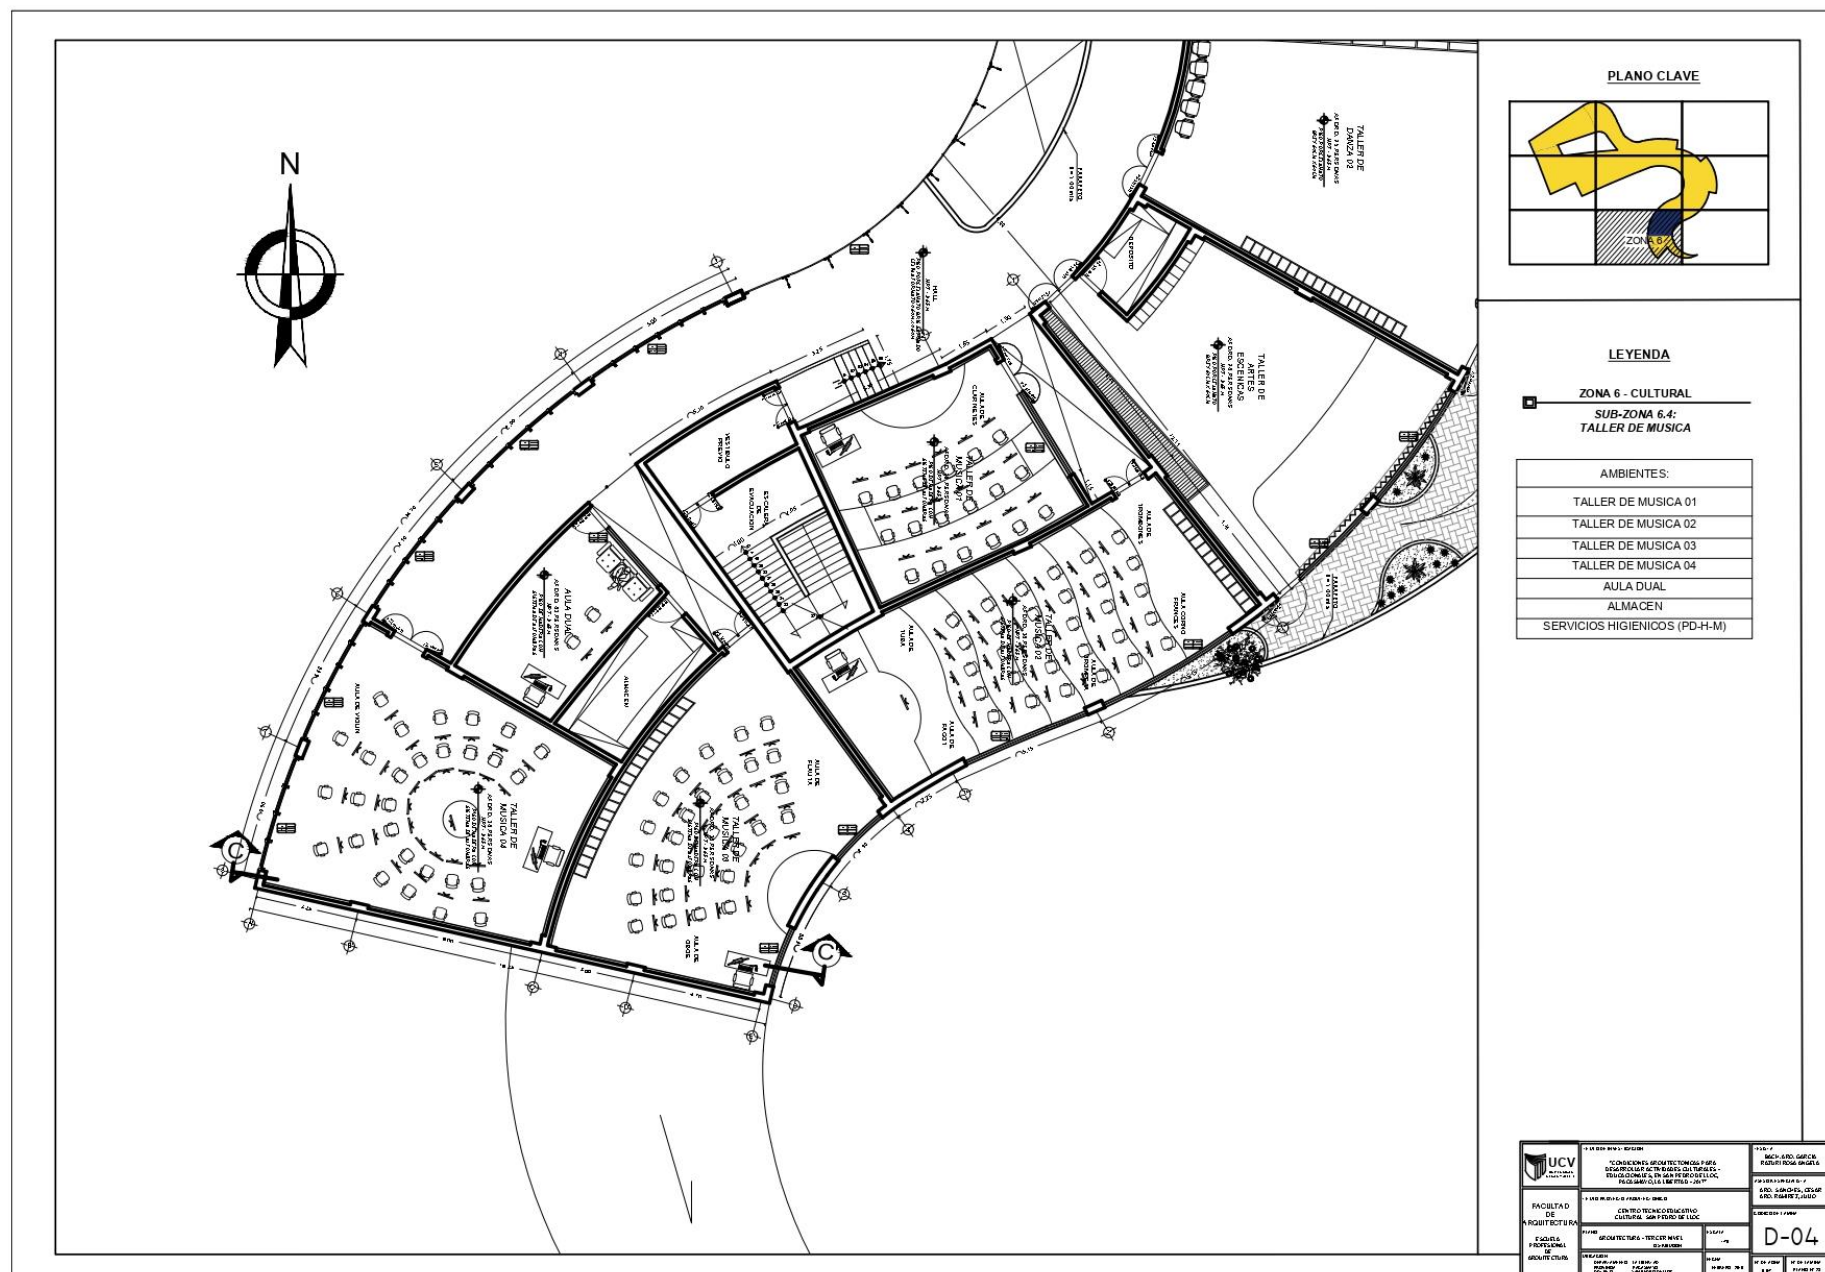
Plano de Desarrollo por Zonas - Plano N° 28 - Lamina N°: D - 04
